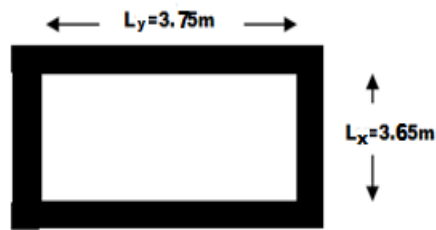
Dalle sur 04 appuis de la cage d'escalier
